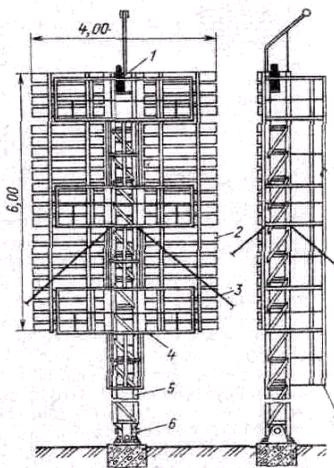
Типовой металлический знак с вантовыми оттяжками
